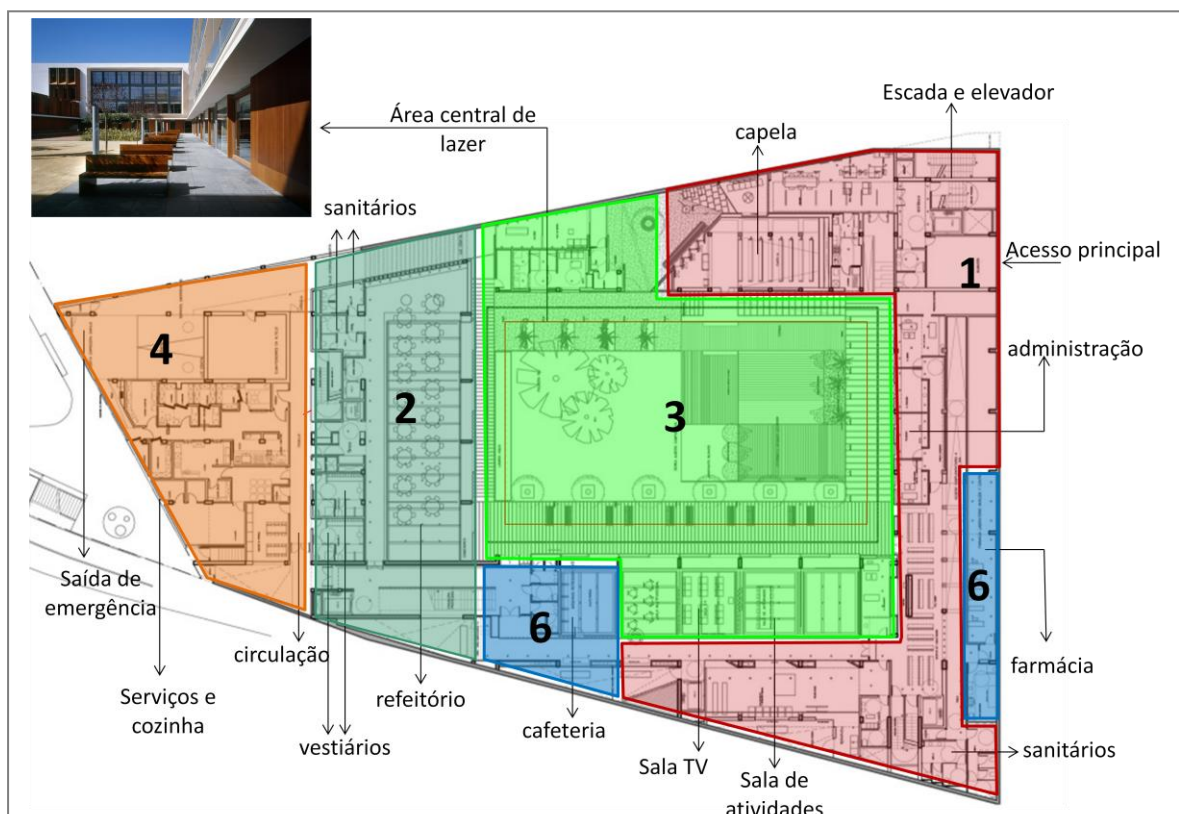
Planta baixa pavimento térreo. Fonte: PENIN (2009).
